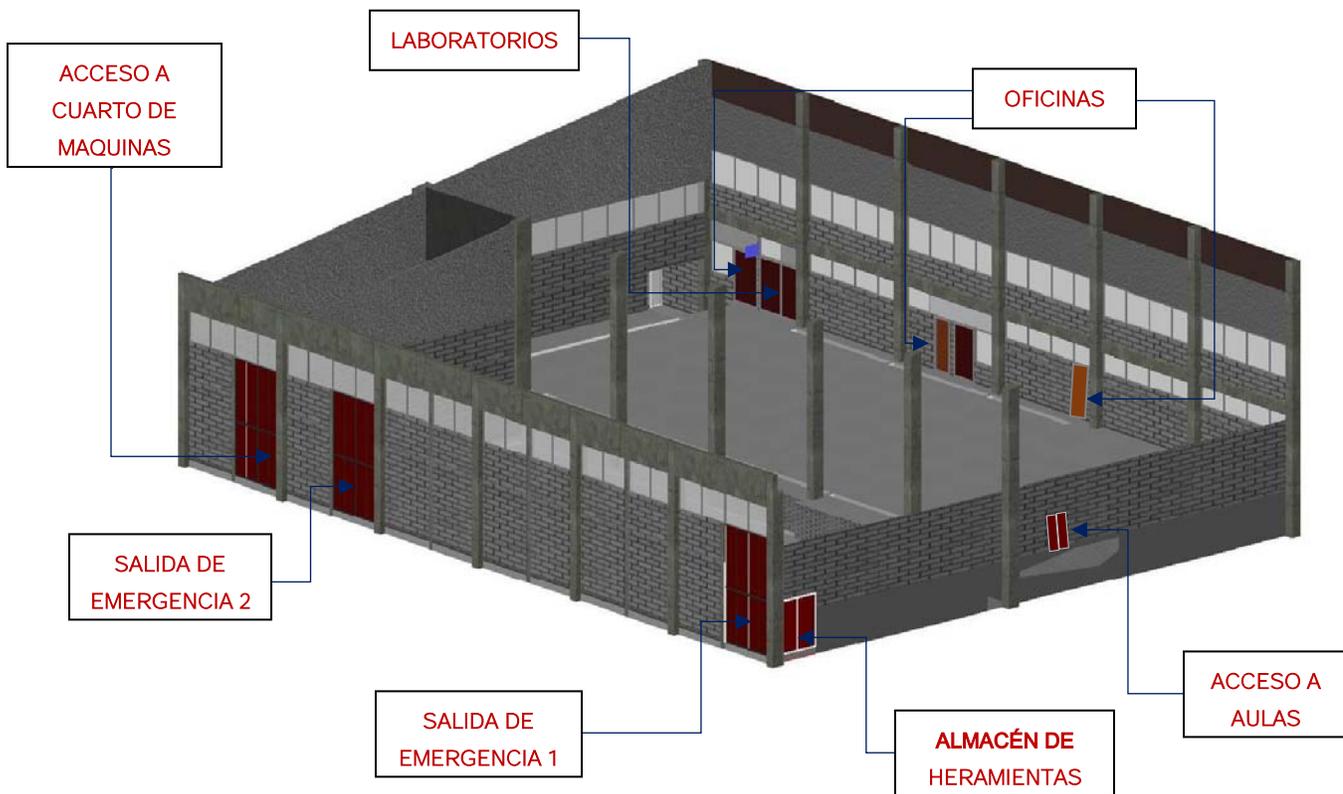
Modelo 3D-Puertas en Planta Piloto.
